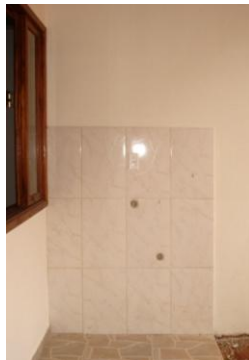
a) Aplicação de azulejos diretamente sobre a PCMM. Fonte: Construpex (2009) e
